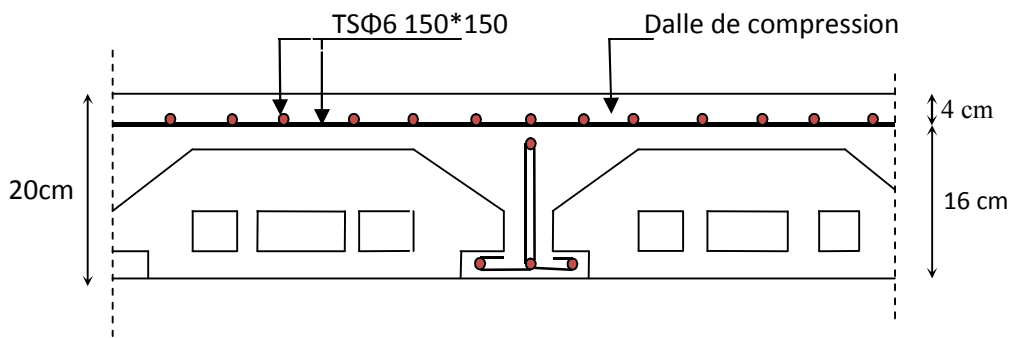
Schéma de ferrailage de la dalle de compression.
